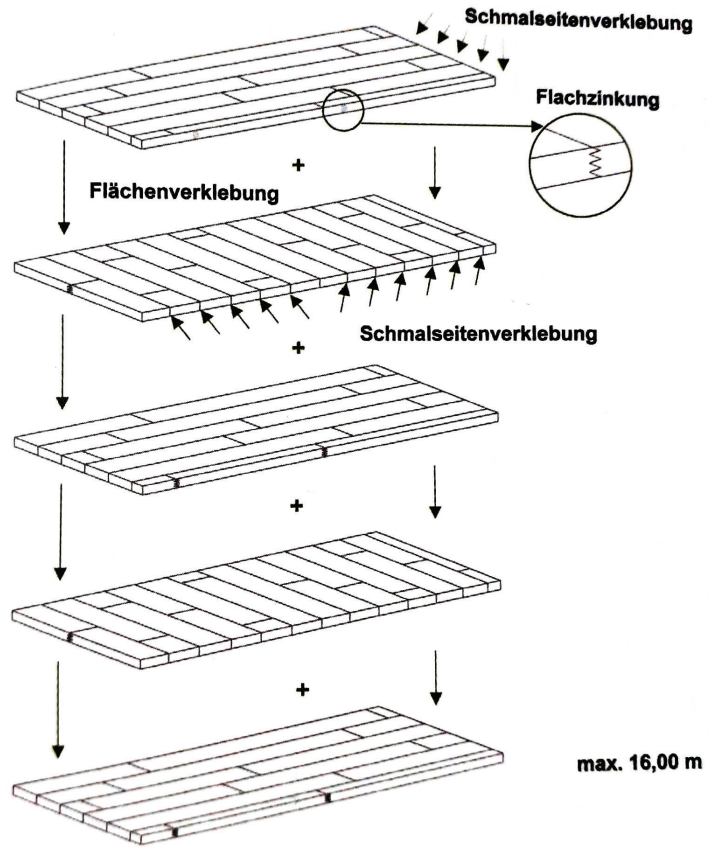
Explosionszeichnung des schichtartigen Aufbaus einer CLT Platte
